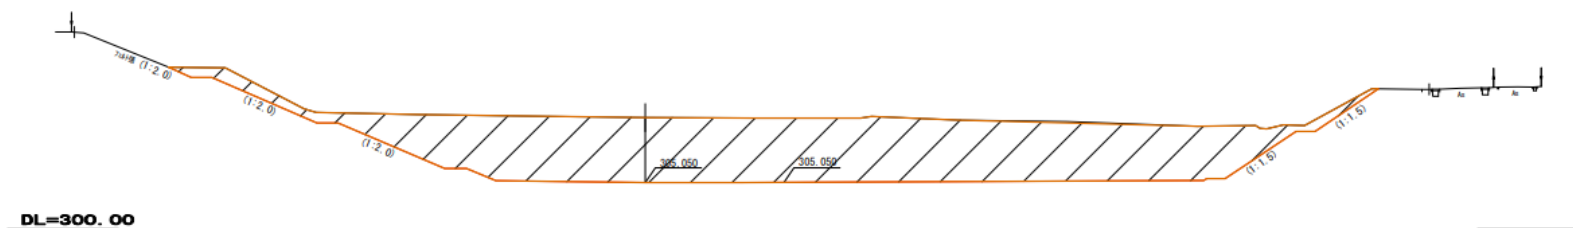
(2) 掘削平面図及び掘削横断面図
